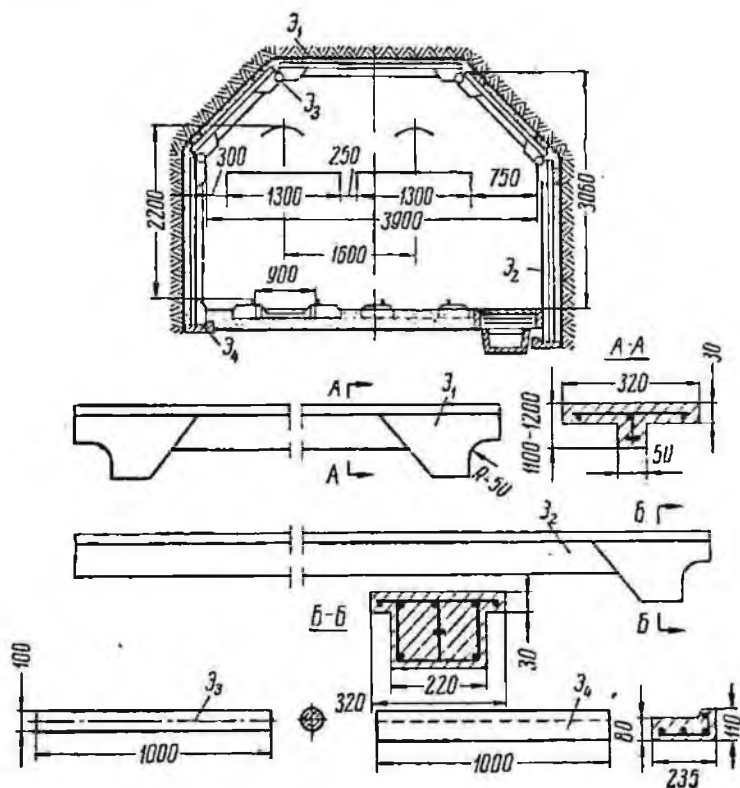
Сборная железобетонная крепь из универсальных ребристых плит (УРПМ)
